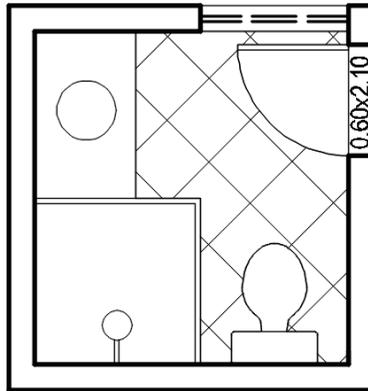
| Representação do corte horizontal a 1,50 m acima do piso da casa, que dá origem à planta baixa
